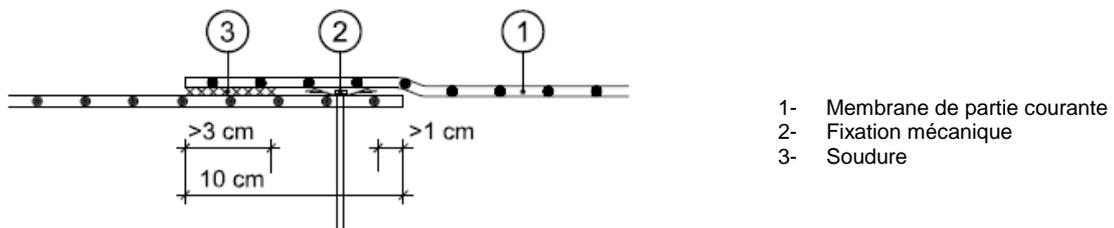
Recouvrement longitudinal avec fixation mécanique
